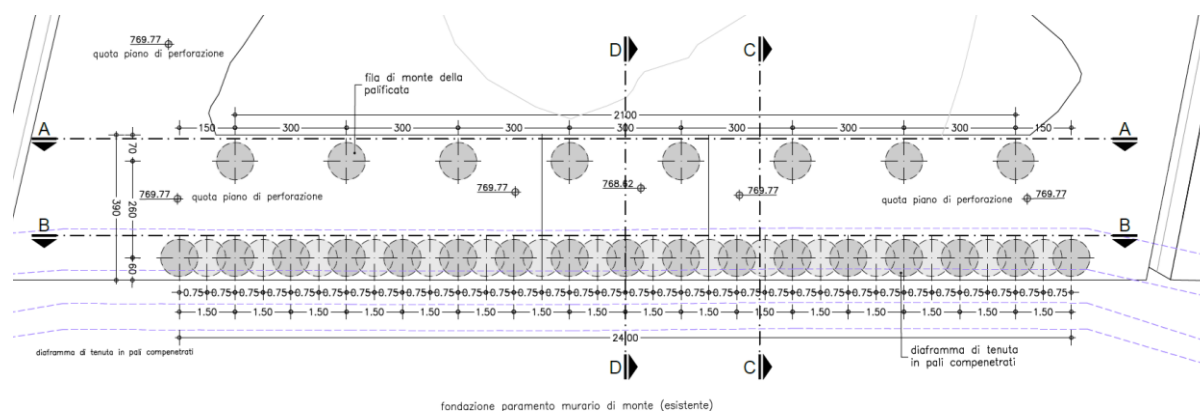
Disposizione in pianta dei pali di fondazione del manto di tenuta
